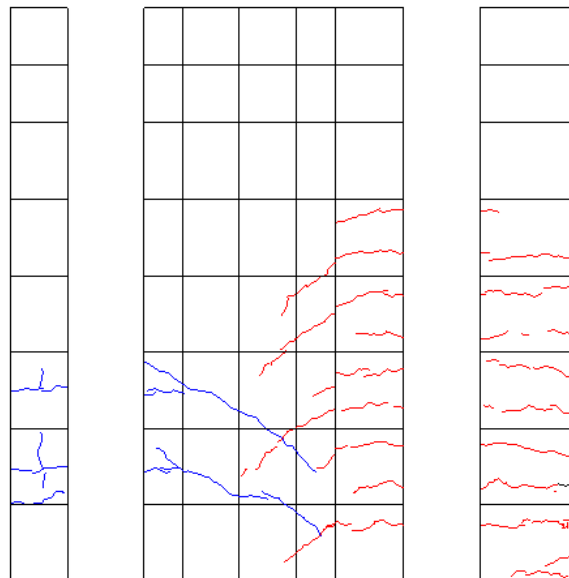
R=-1/400 ひび割れ図
